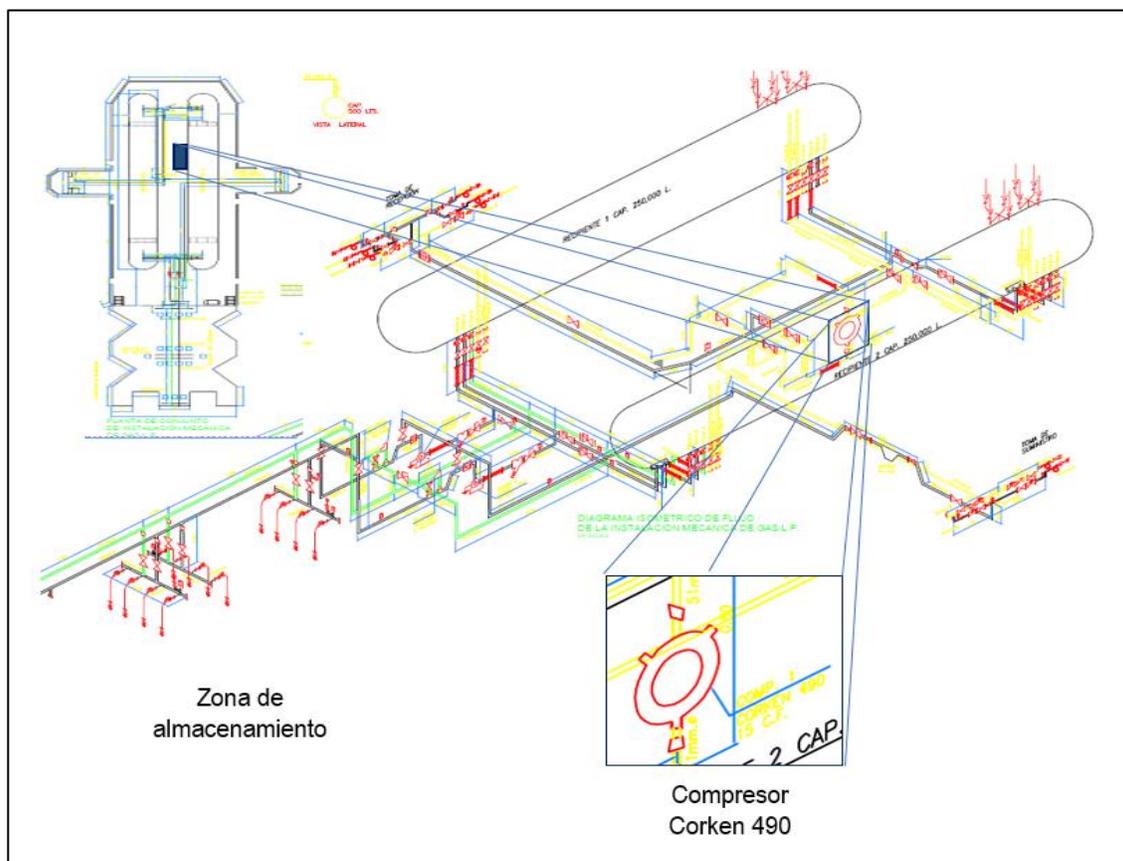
Localización en planta del equipo de impulsión (compresor). Adaptación del plano mecánico de la planta.
